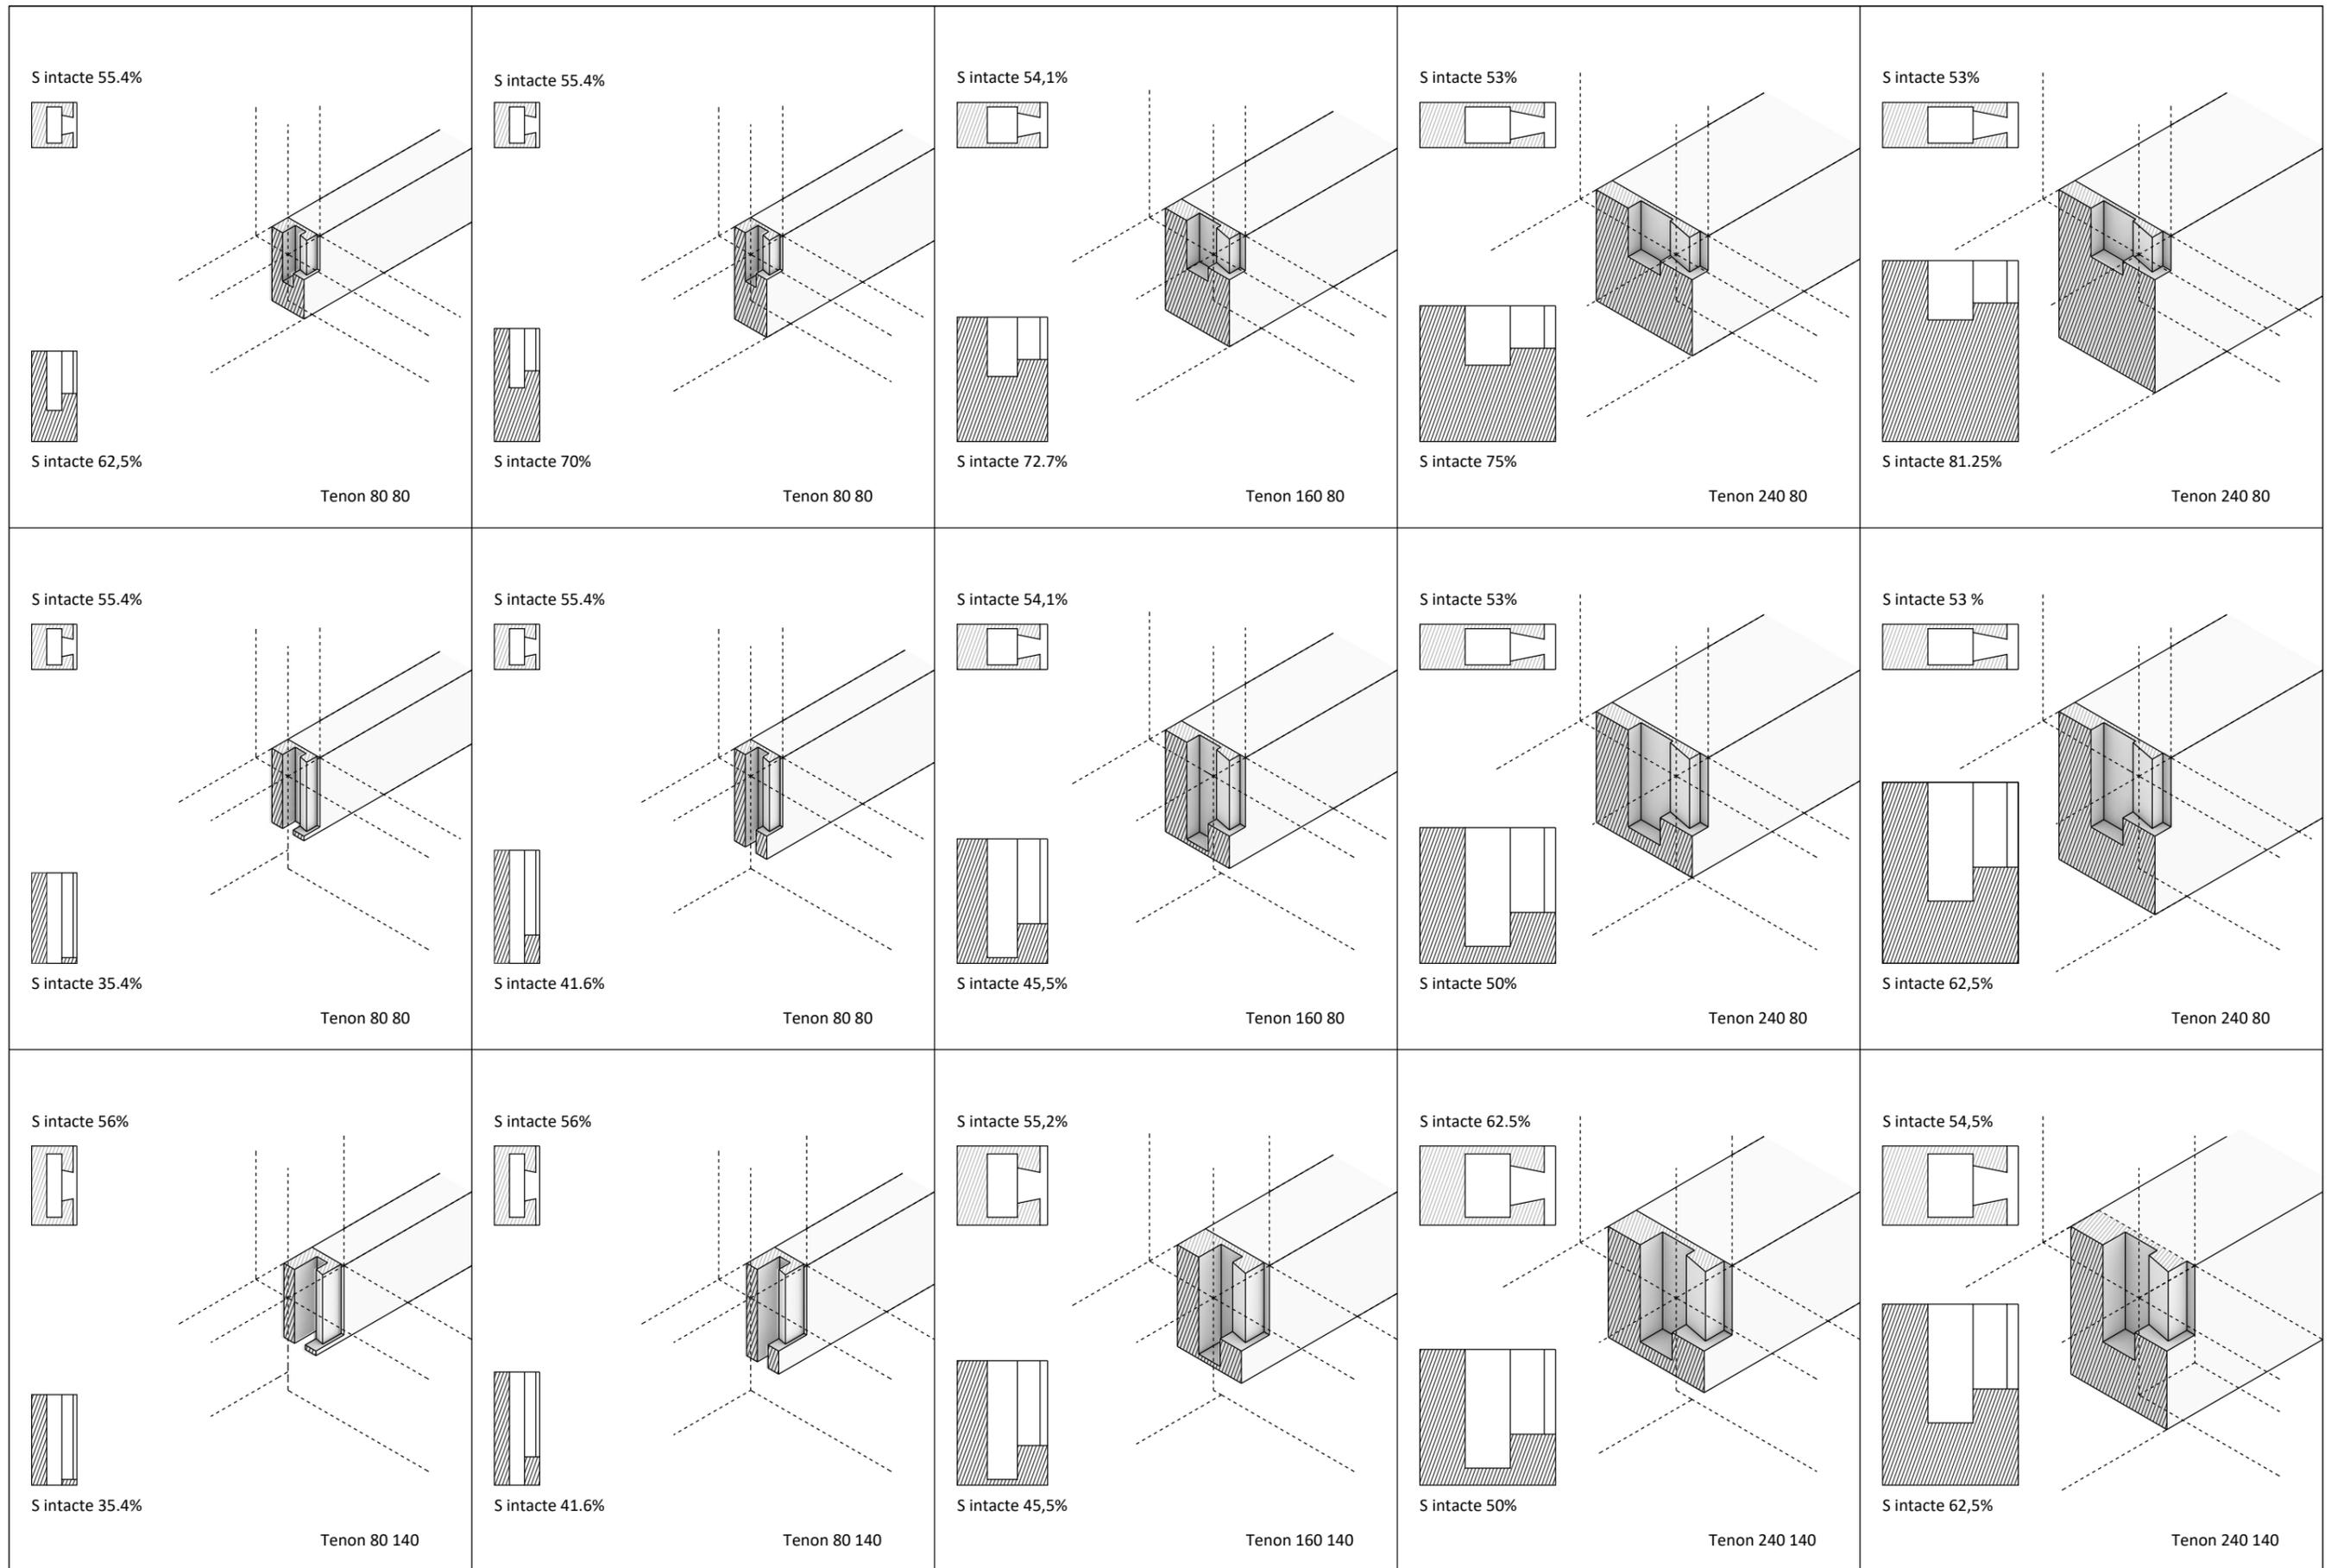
Tableau illustrant des variation de sections des poutres de support et des poutres de plancher
